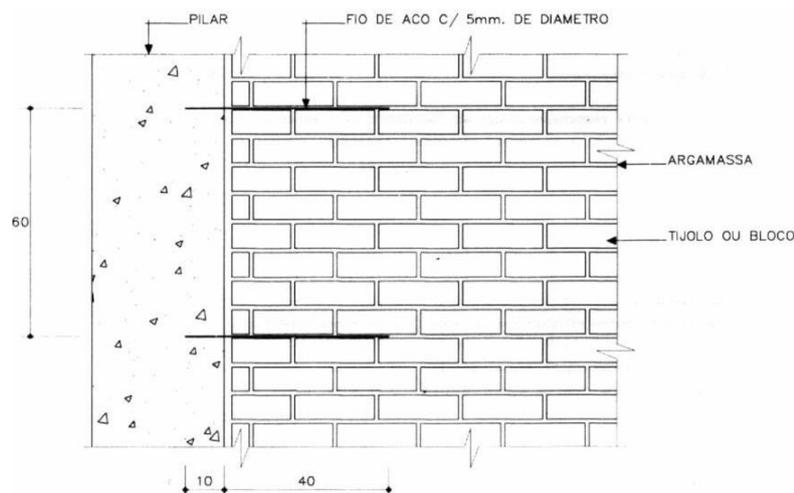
Detalhe ligação de alvenaria com pilares de concreto.
